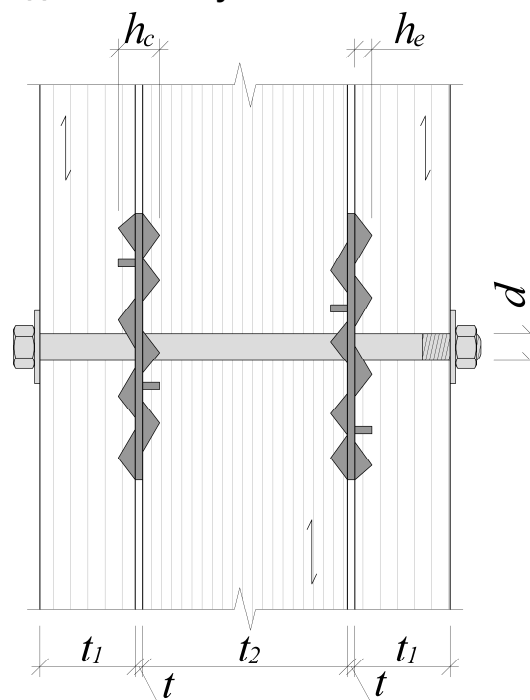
Общий вид соединения с зубчатыми пластинами
